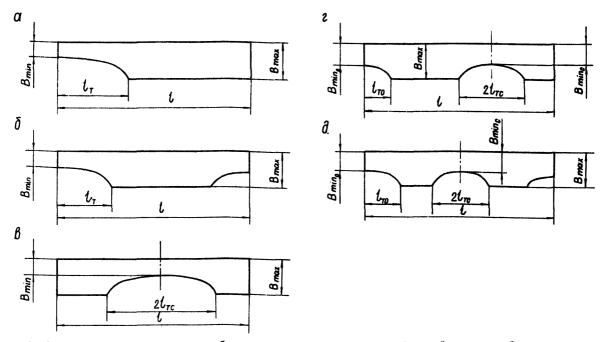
Эпюры жесткооти железобетонных элементов: а-с одной зоной трешинообразования на приопорном участке; б-с двумя зонами трешинообразования на приопорных участках; в-с одной зоной трешинообразования в пролете; г-с двумя зонами трешинообразования - в пролете и на приопорном участке; д-с тремя зонами трешинообразования - в пролете и на приопорных участках
